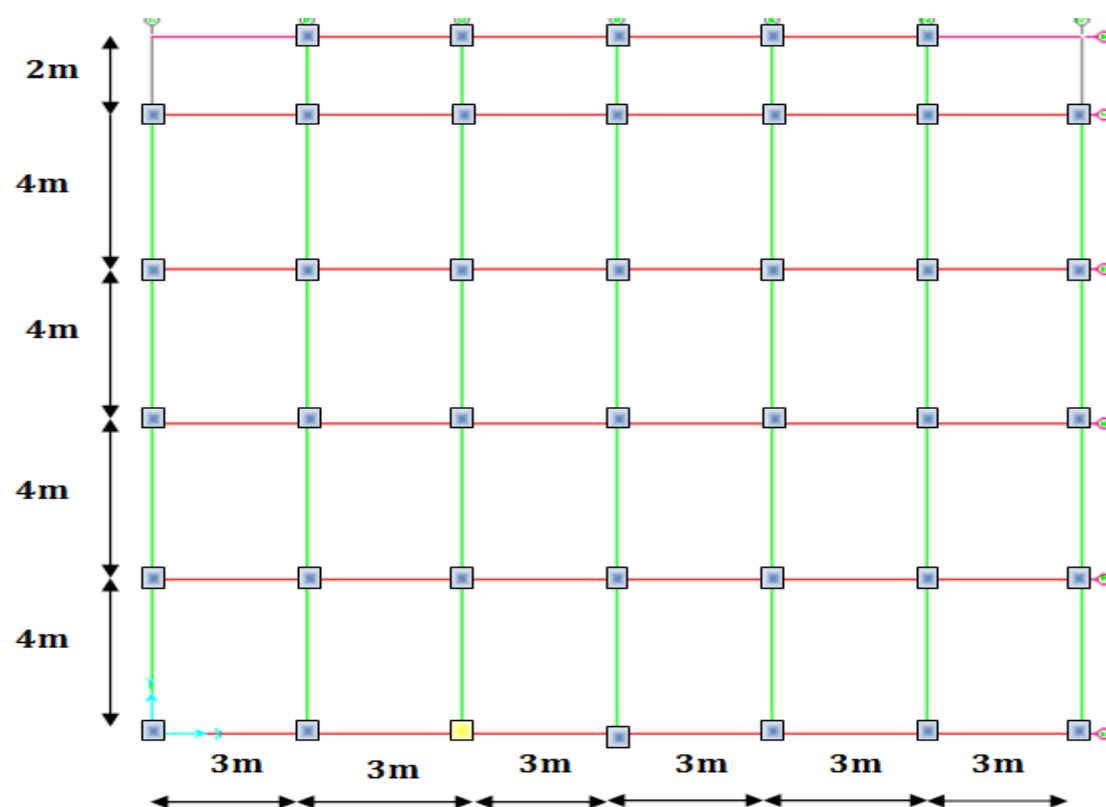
la géométrie en plan et en élévation de la structure.
